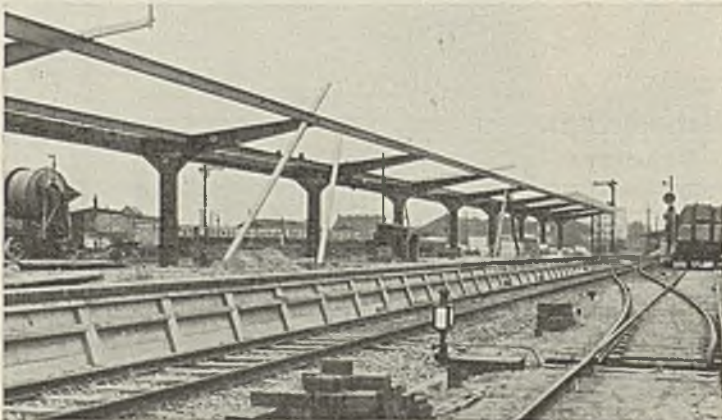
Bahnsteigdach in Bremen-Neustadt.
